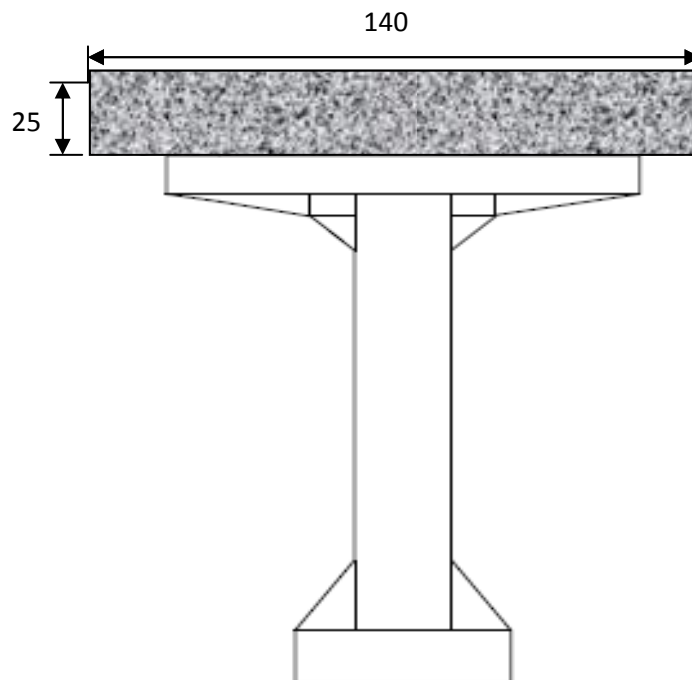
La section d'about de la poutre en BP plus l'hourdis général.
